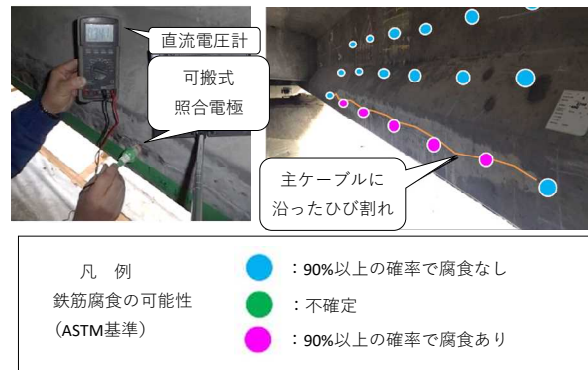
主ケーブルに沿ったひび割れ部の自然電位測定
